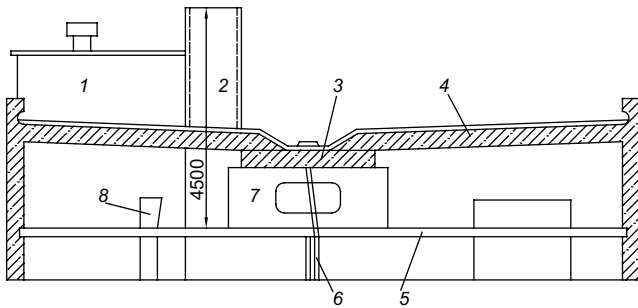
Теплый чердак: 1 – машинное помещение лифта; 2 – вытяжная вентиляционная шахта; 3, 4 – керамзитобетонная панель покрытия; 5 – панель чердачного перекрытия; 6 – водосточный стоик; 7 – опорная панель; 8 – оголовок вентиляционного блока
